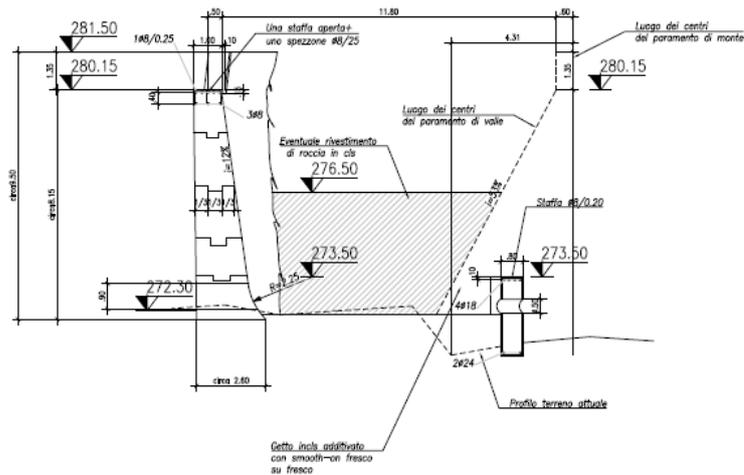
Sbarramento SA02 Percussente – Profilo di progetto
